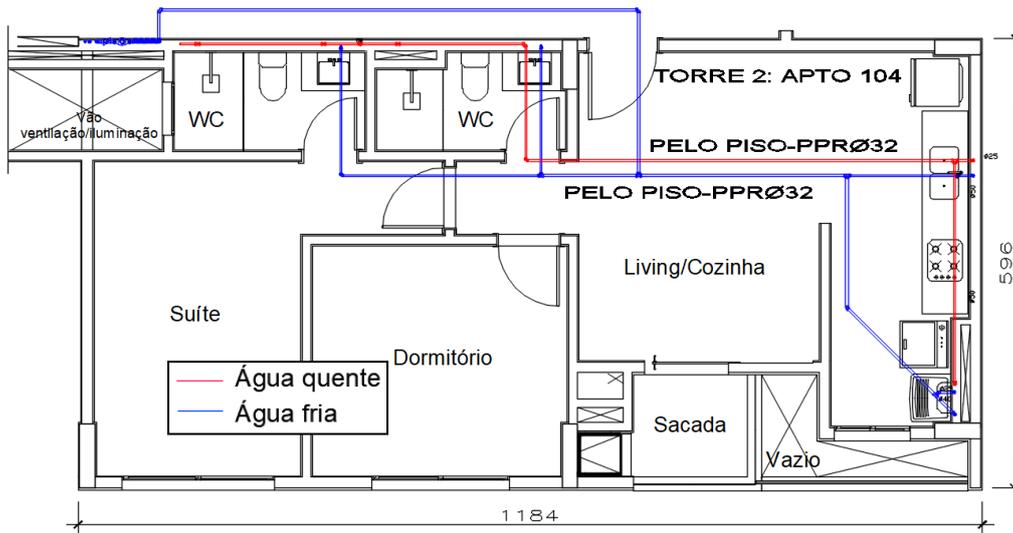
Planta baixa da instalação hidráulica modificada para a planta baixa da Figura 2.
